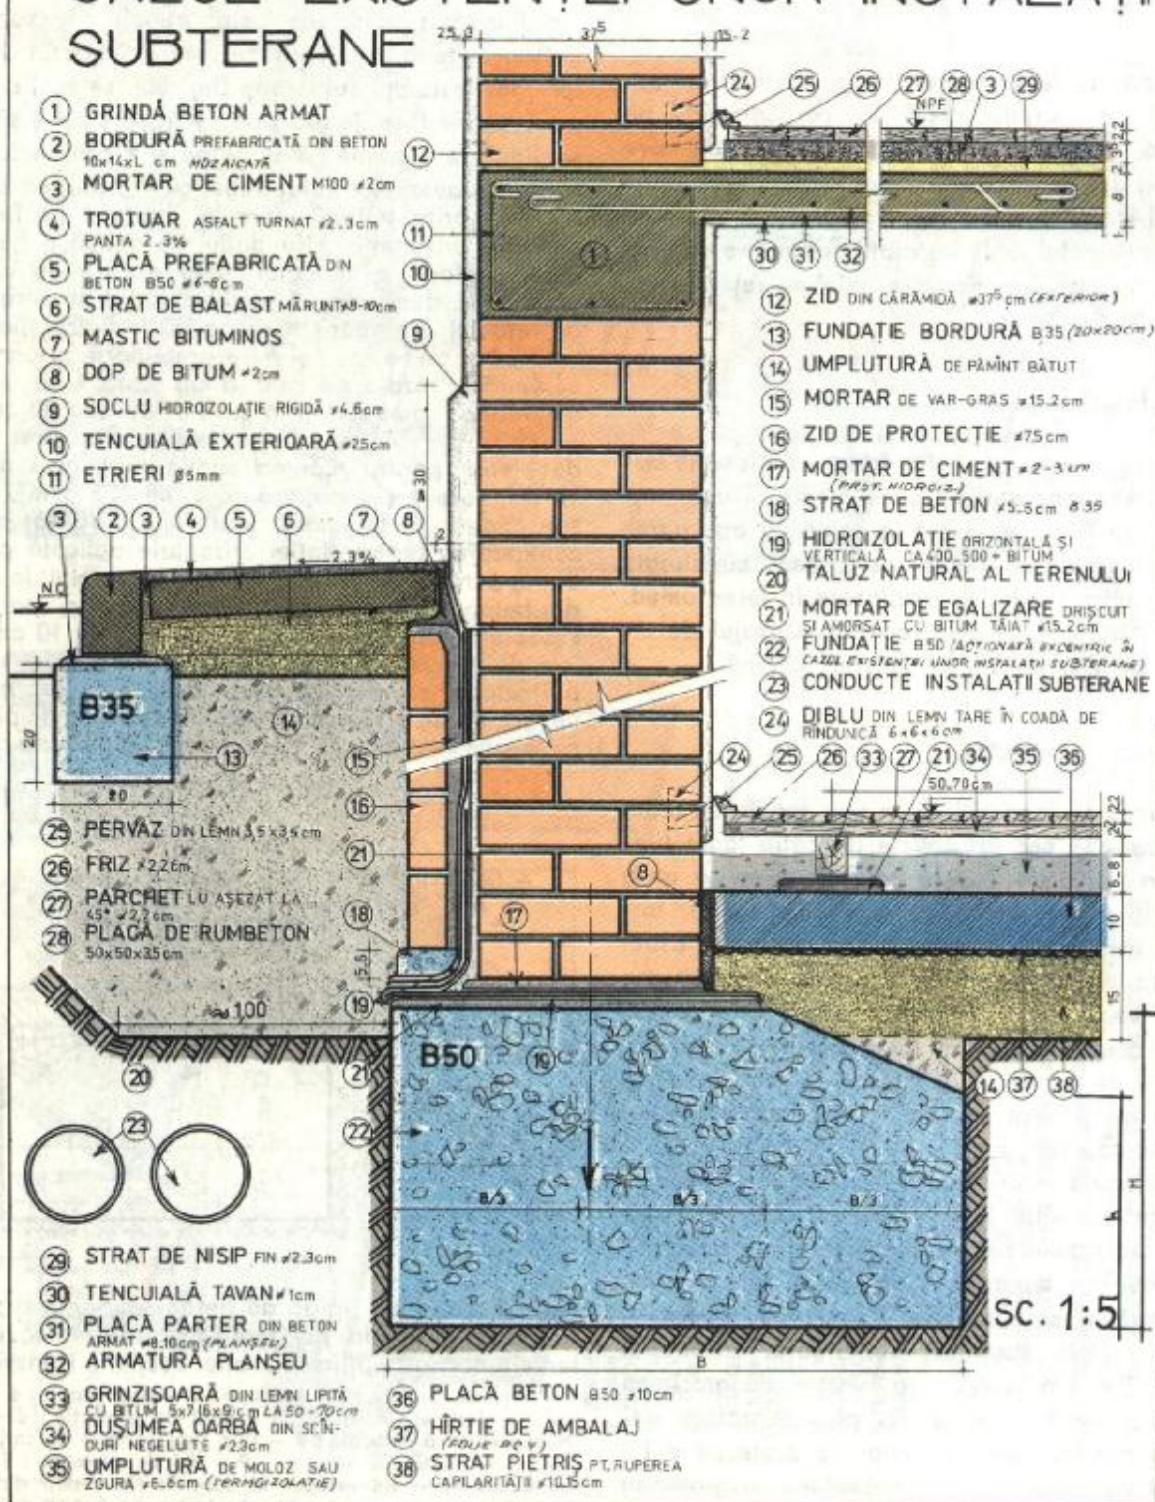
Fundație rigidă de beton simplu, sub zid exterior de cărămidă, acționată excentric, în cazul existenței unor instalații subterane. Secțiune transversală:
